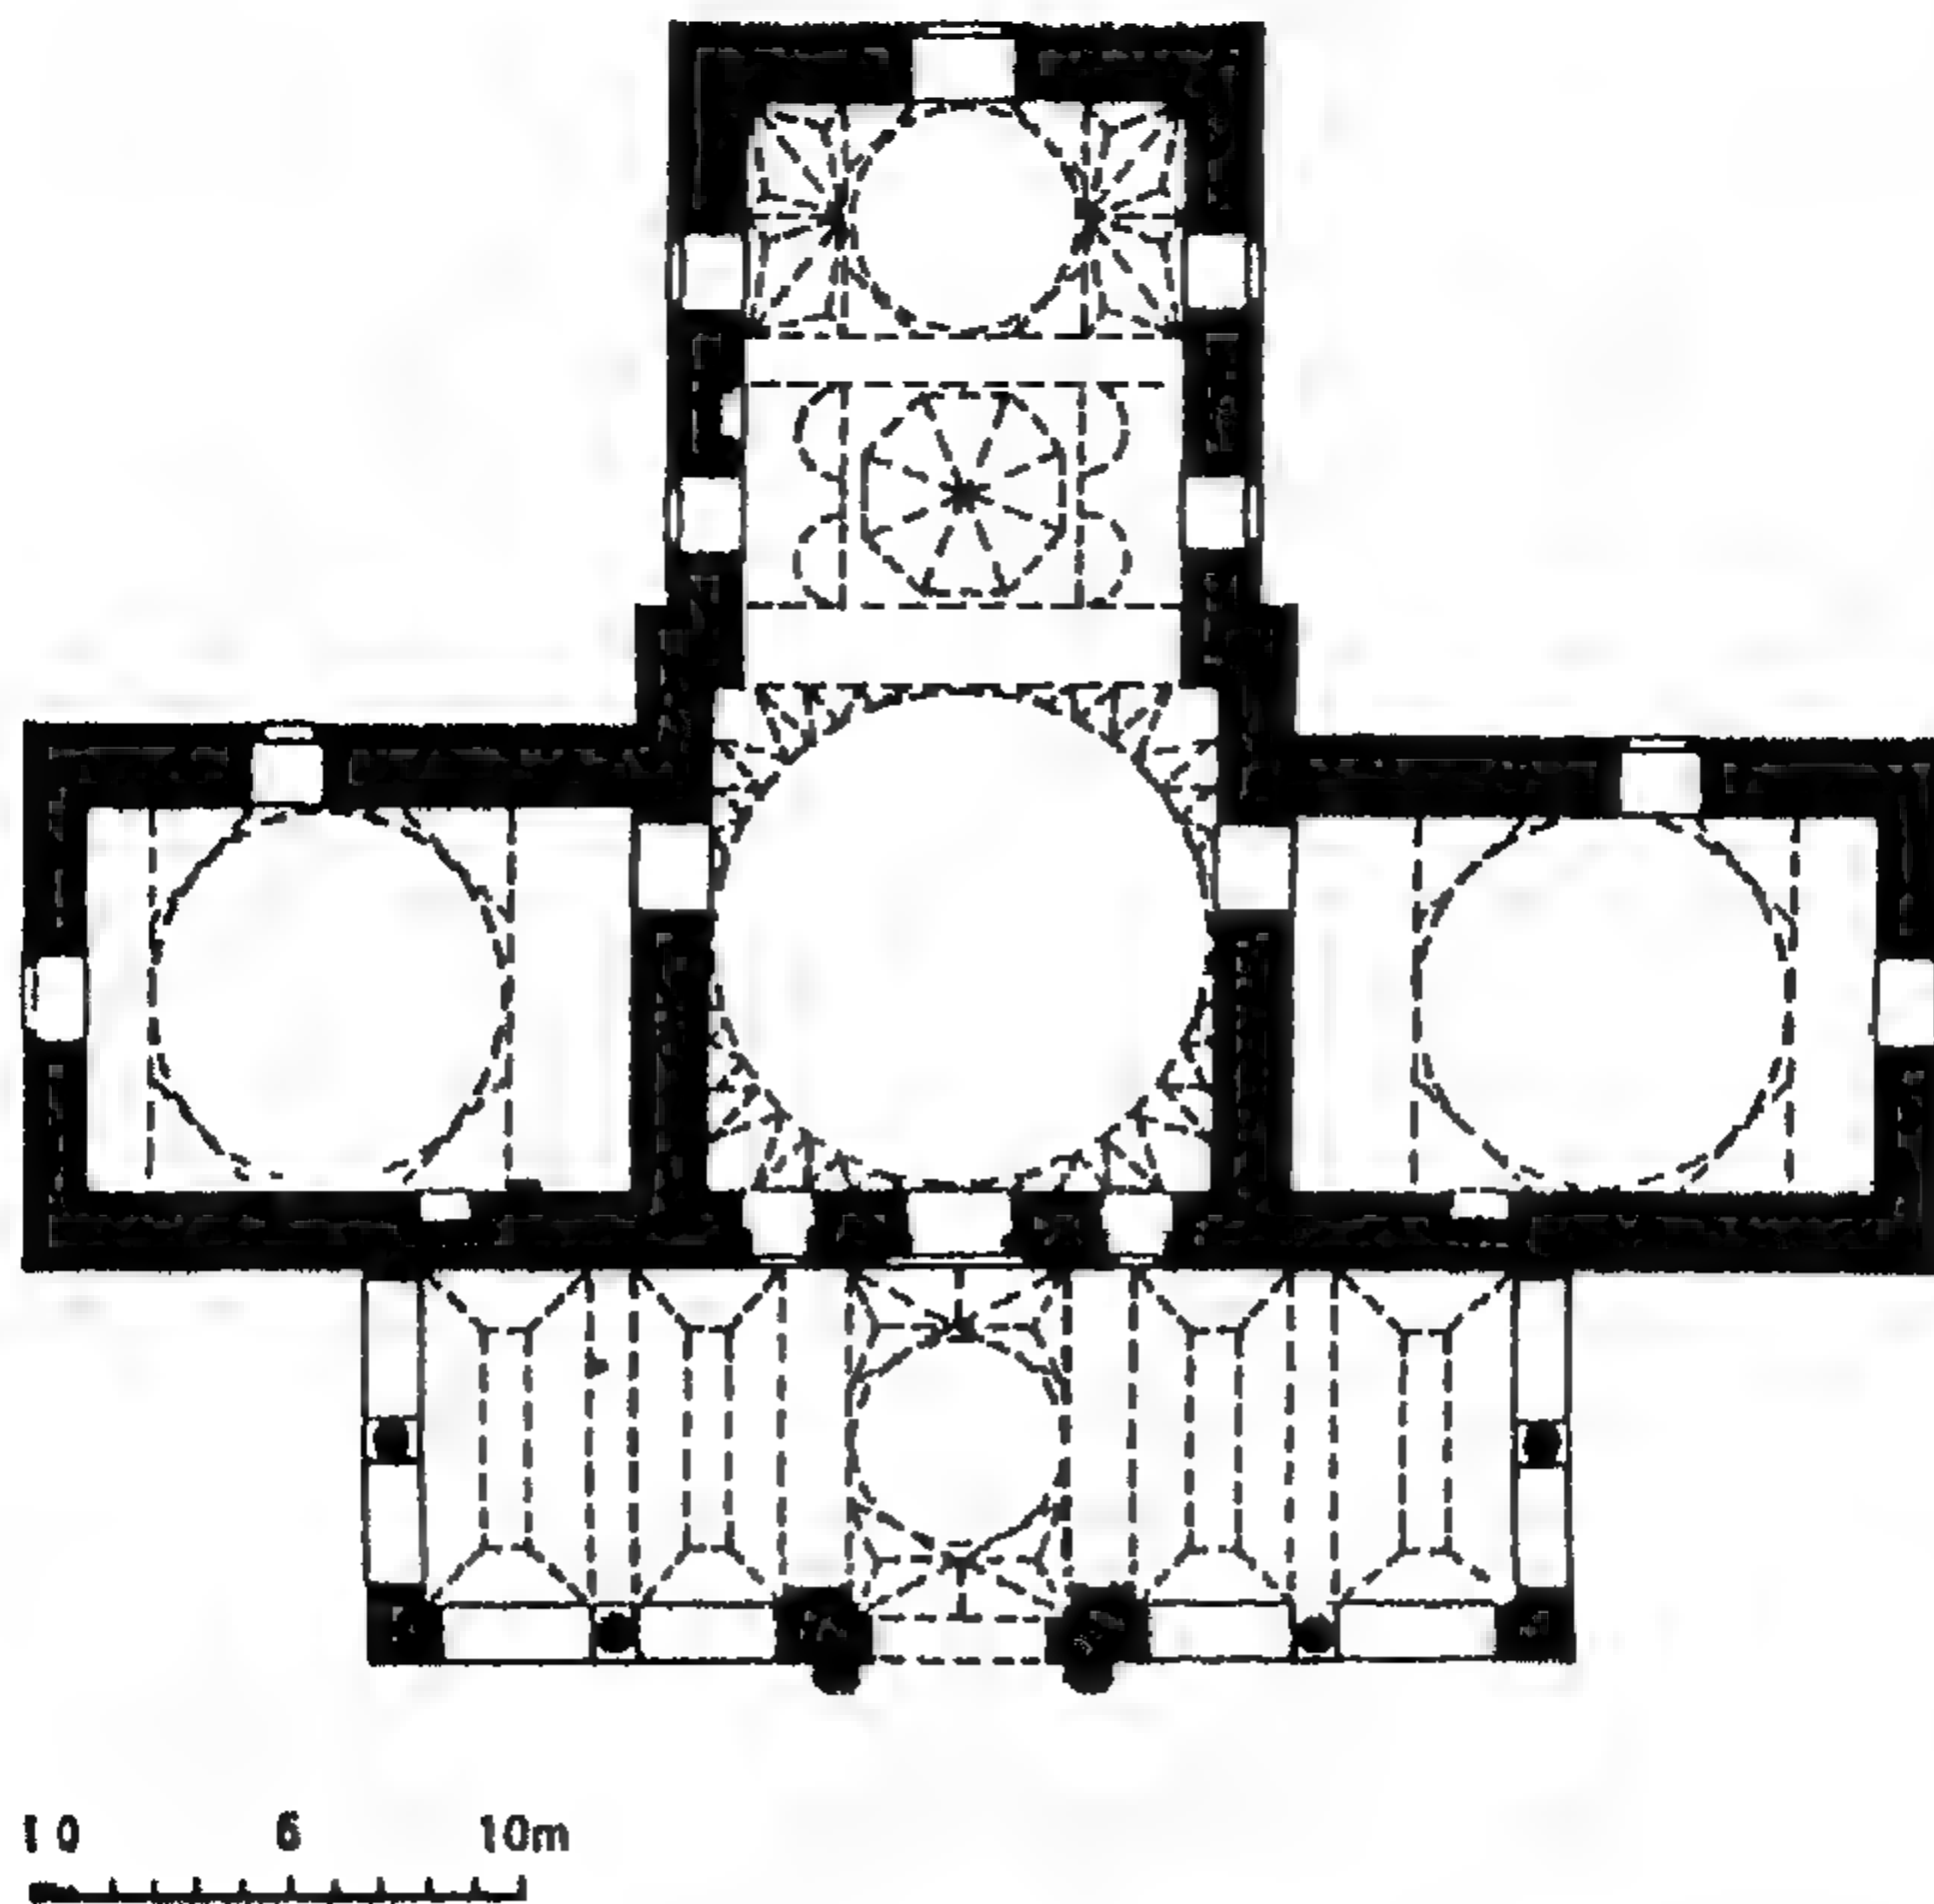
مسقط أفقي لجامع حمزة بك في بورصة (اوبروسه) (عن : Wilde) .
